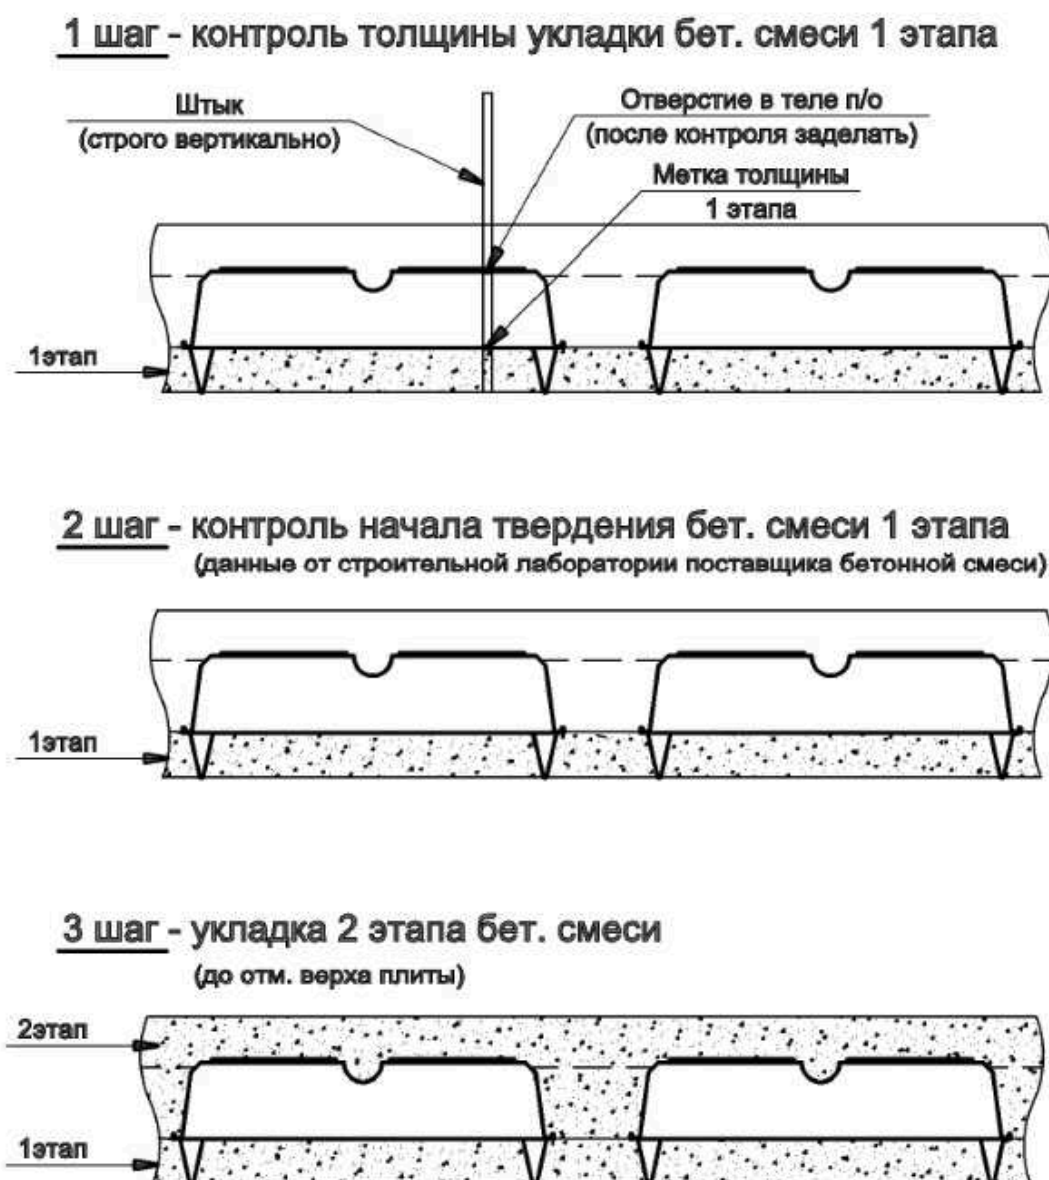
Технологическая карта укладки бетонной смеси плиты первого и второго этапов
